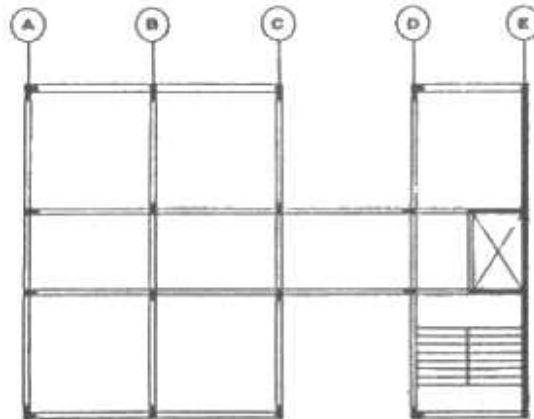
Planta de edificio con rigidez en el extremo y reducción de diafragma, recuperado de: Blanco Blasco (1994) “Estructuración y Diseño de Edificaciones de Concreto Armado”
